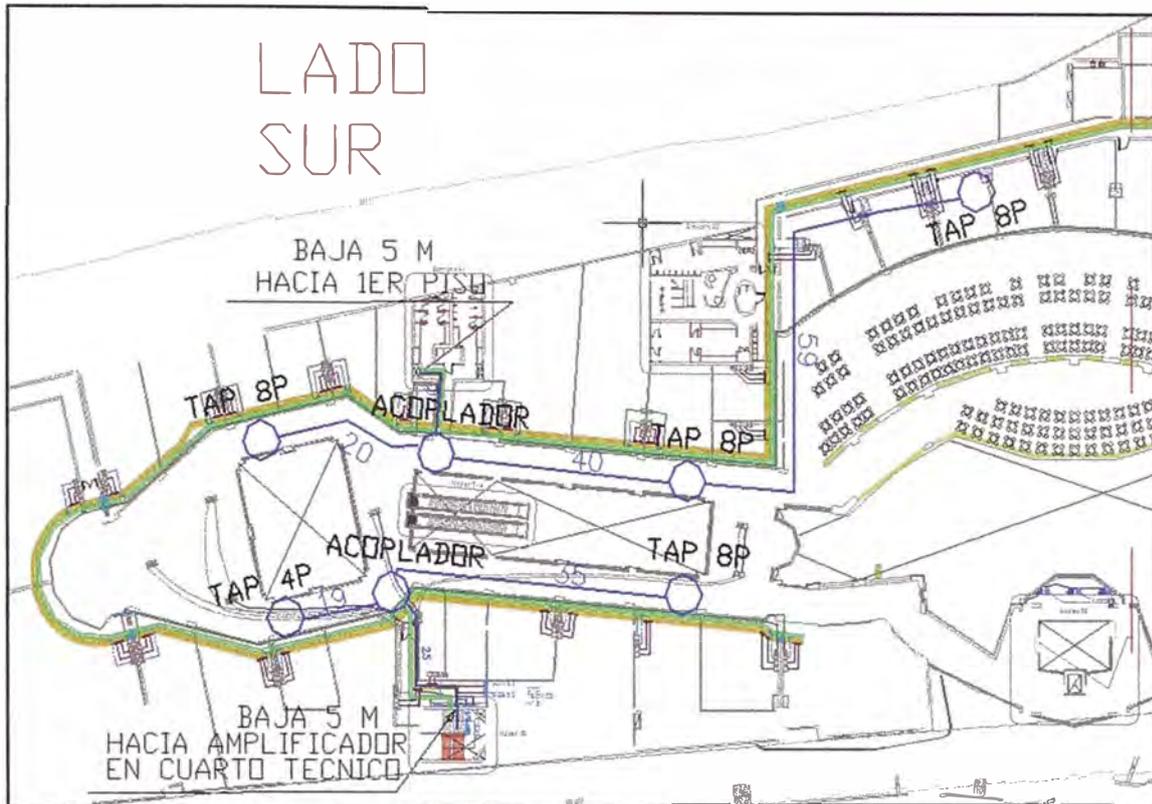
Planta alta, sector sur del C.C. Comercial Parque Lambramani. Fuente: Elaboración propia.
